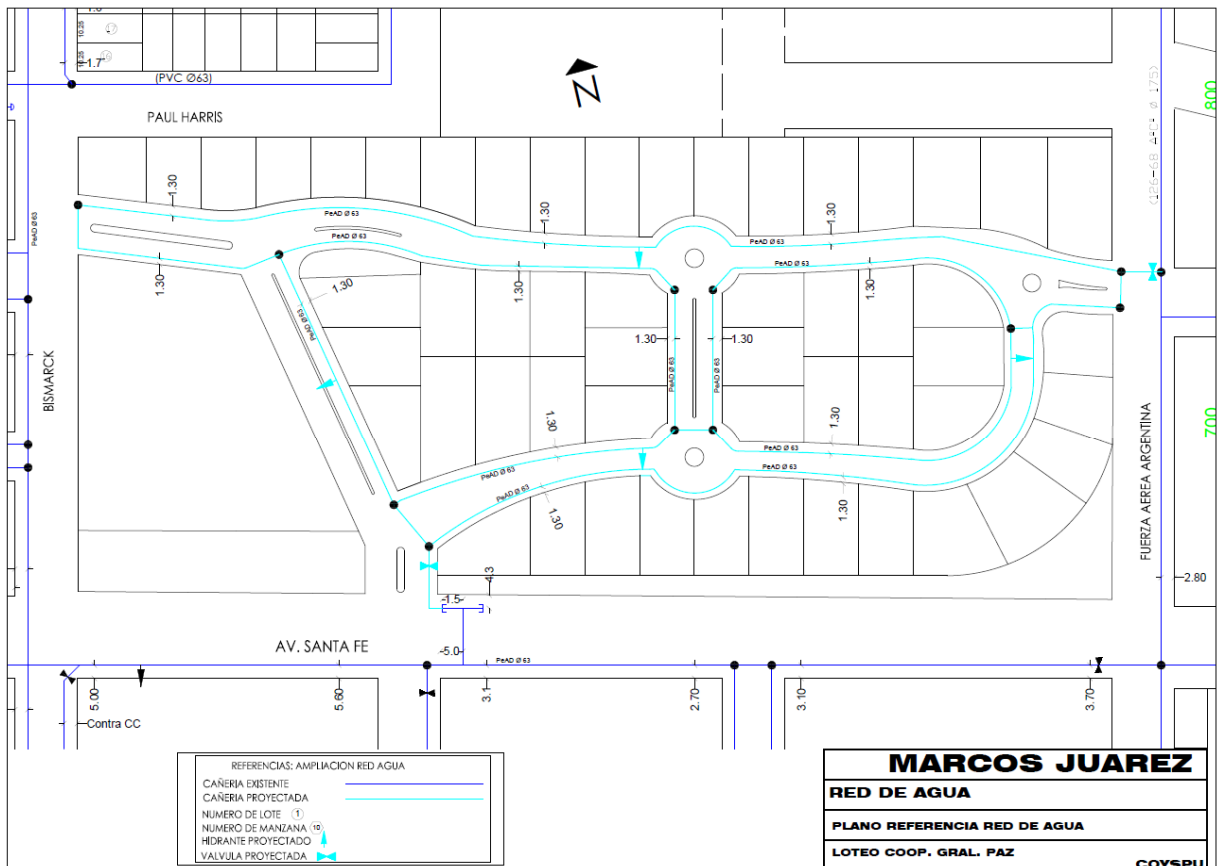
Plano de proyecto de red de distribución de agua potable ejecutado por Coyspu.
